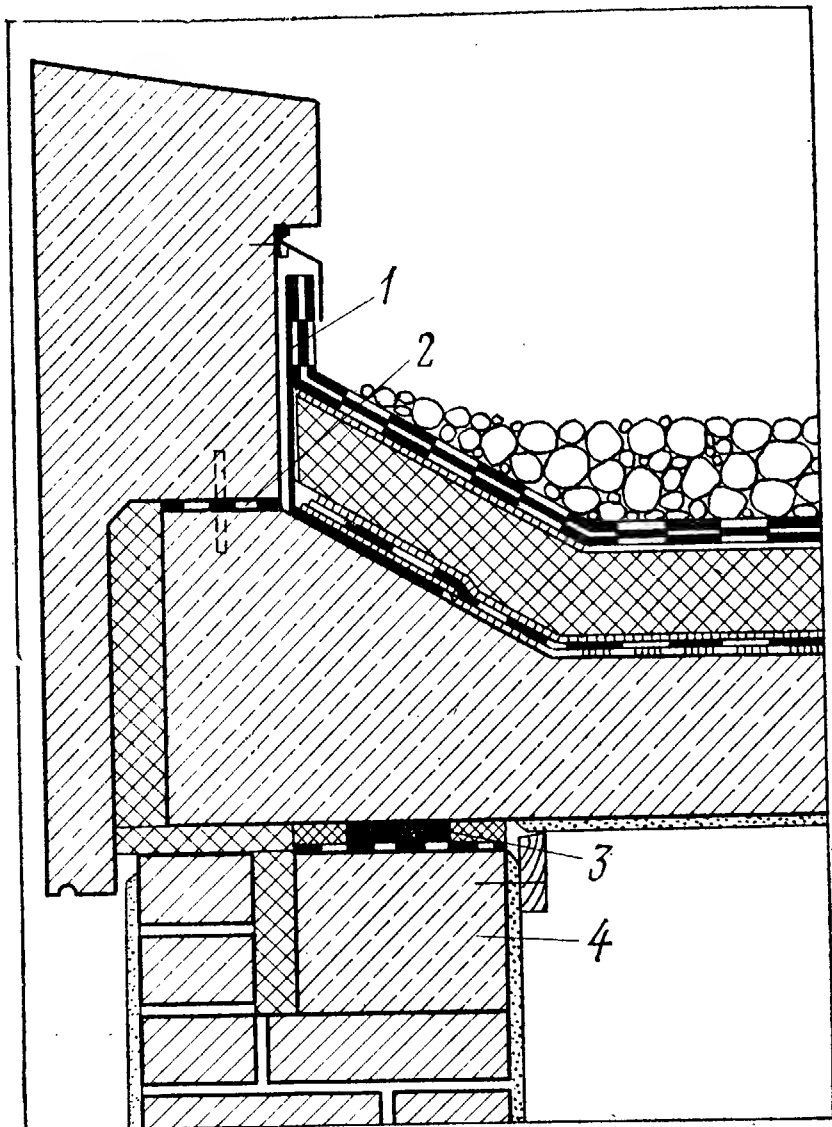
Устройство подвижной опоры кровельного покрытия. Железобетонное покрытие через прокладку из эластомера и допускающую скольжение фольгу (3) укладывается на перемычку (4). Неутепленный с наружной стороны железобетонный парапет вследствие ожидаемых больших тепловых удлинений также опирается на плиту покрытия способом, допускающим сдвиг (2). Кровельное покрытие полностью отделено от подвижного парапета (1)
